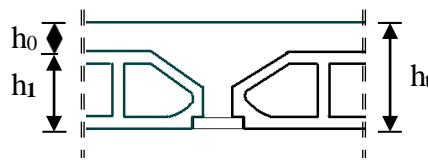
Coupe transversale d'un plancher à corps creux
